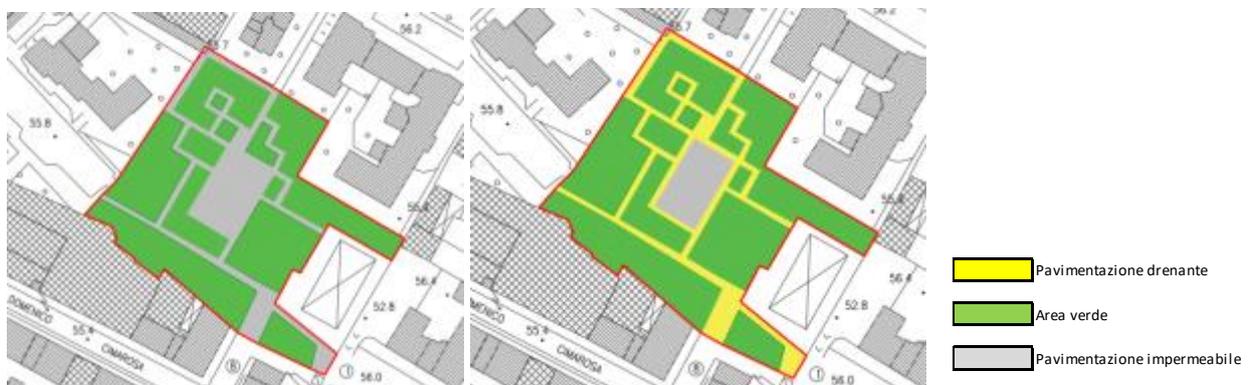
Sinistra: Planimetria stato di fatto area parco in via Vivaldi; Destra: Planimetria stato di progetto PROGETTO PRATO PIU'
